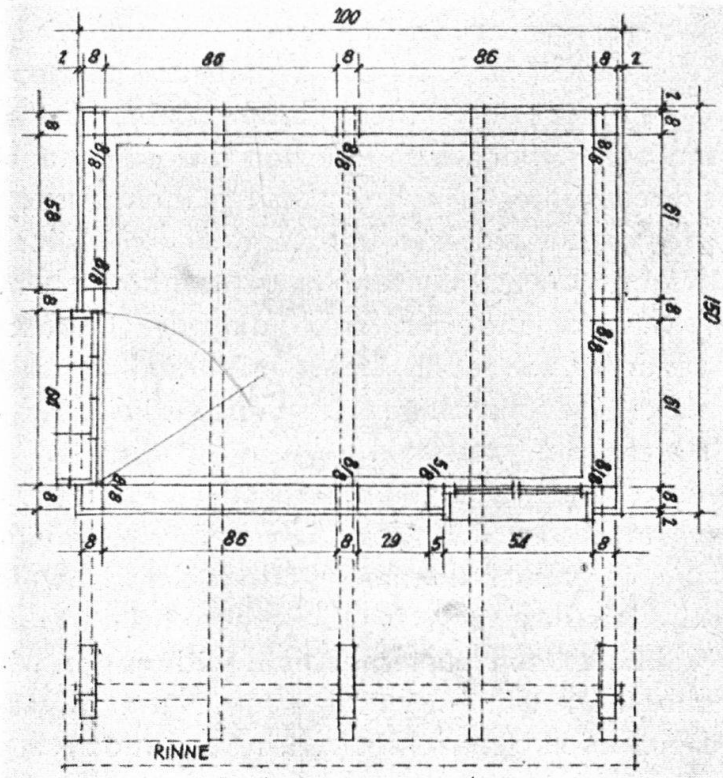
Prämiierter Entwurf „Gäli Rüebe“. Grundriss. — Fig. 5. Projet primé «Gäli Rüebe». Plan.
